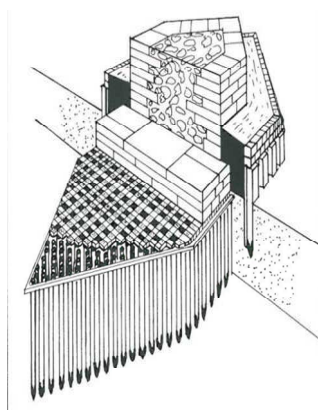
Coupe d'une des piles du pont de la Trésorerie (Mesqui, 1986)
